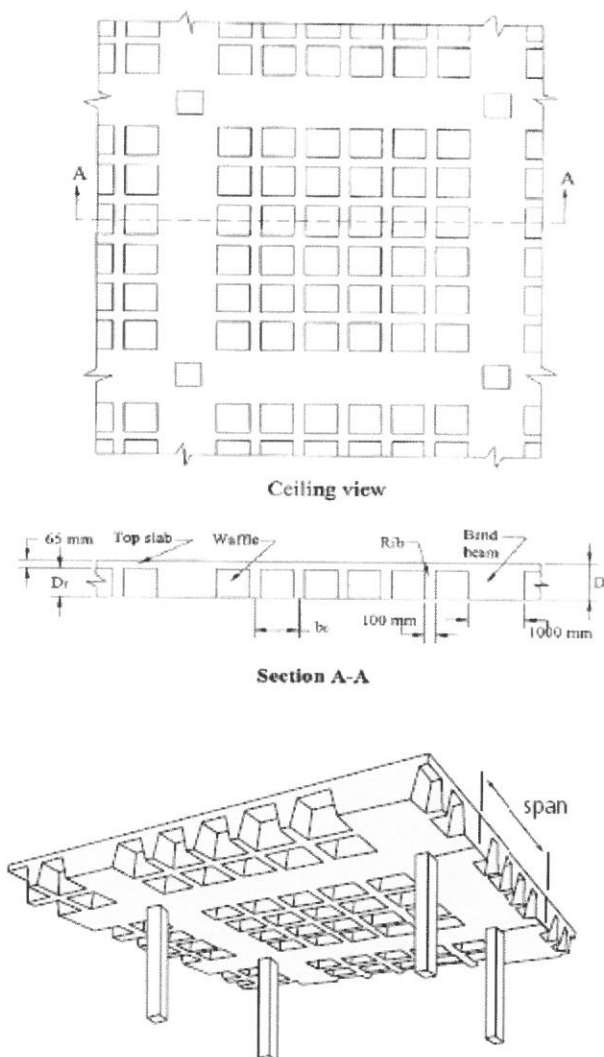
Plan și secțiune transversală pentru planșeu casetat propus
